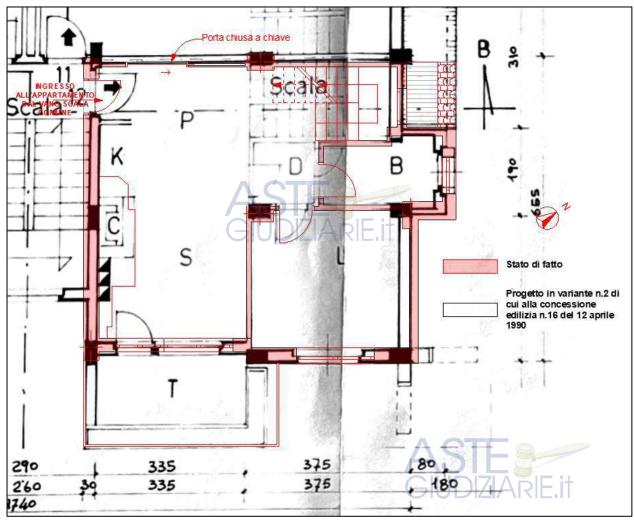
Pianta stato di fatto del piano secondo sovrapposta alla pianta del progetto in variante n.2 di cui alla concessione edilizia n.16 del 12 aprile 1990.
